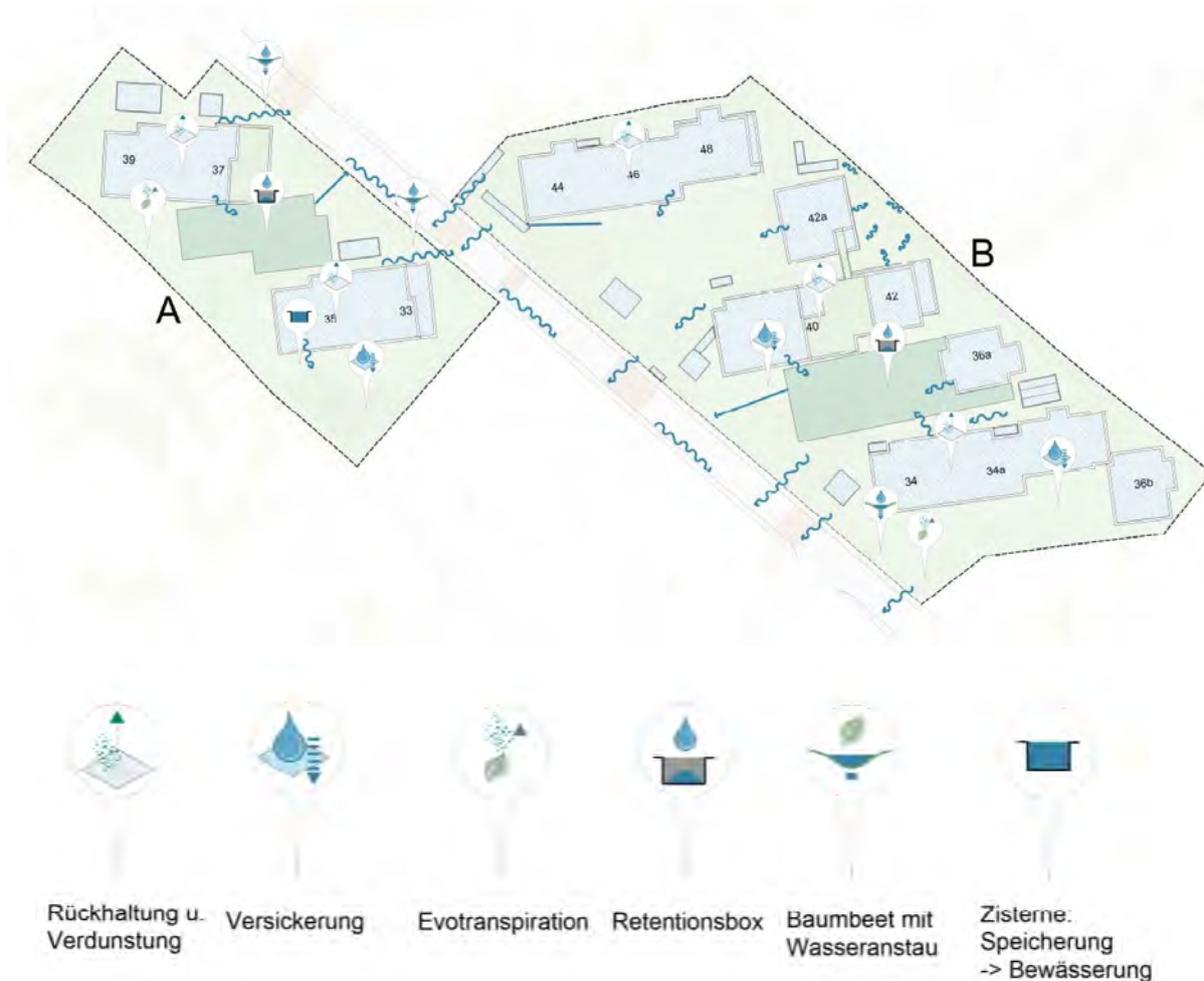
Regenwasserkonzept, Planstatt Senner 2025
